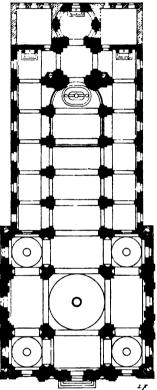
St. Peter zu Gent. Grundriss.
